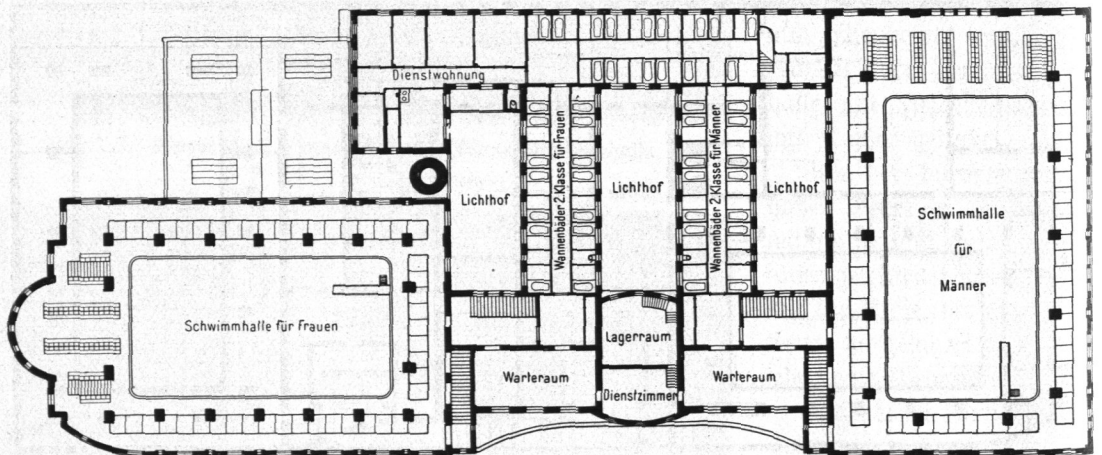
Badeanstalt Hammerbrook, Obergeschloß, Grundriß.
